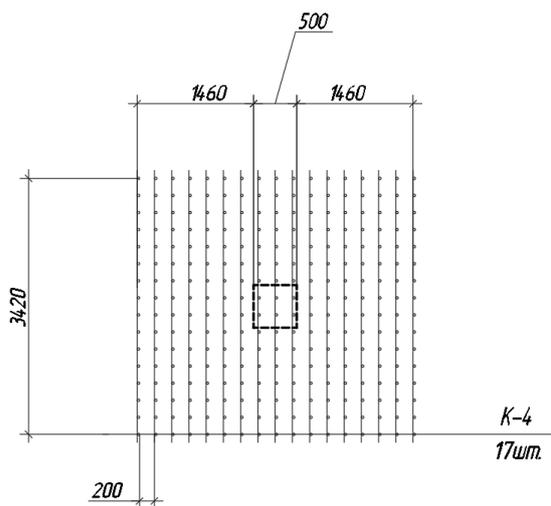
Армирование участка плиты перекрытия в зоне продавливания
